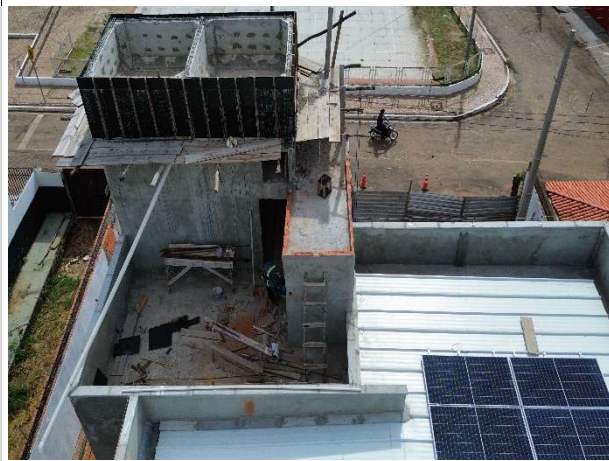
execução de SPDA, cobertura e impermeabilização
